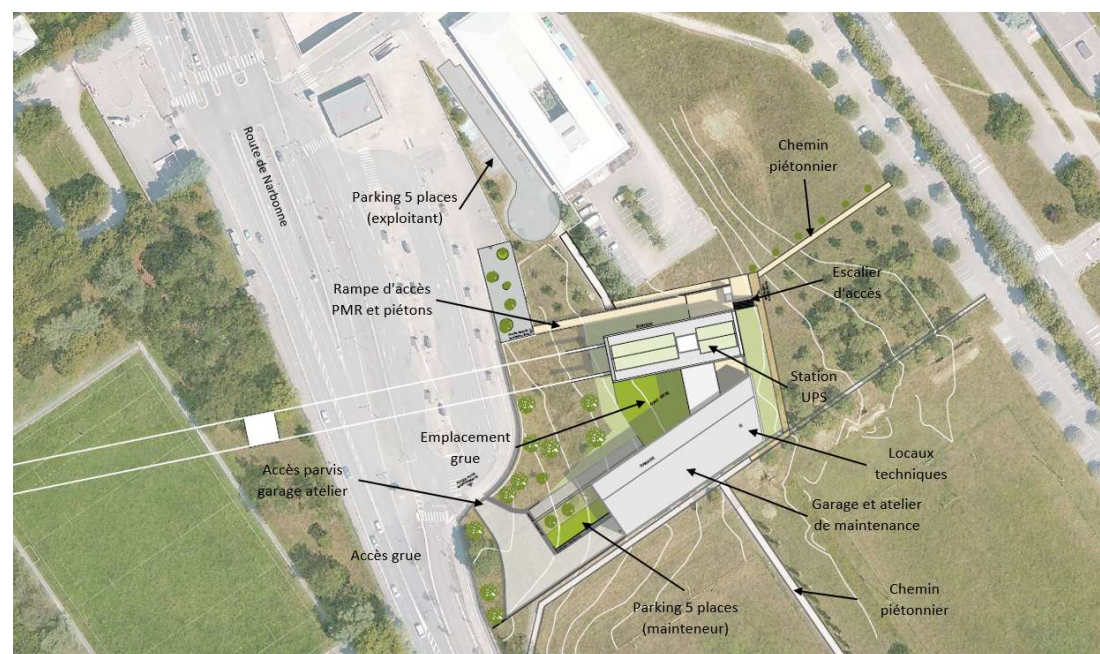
Détails de la station UPS (source : Groupement POMA, 2018)
